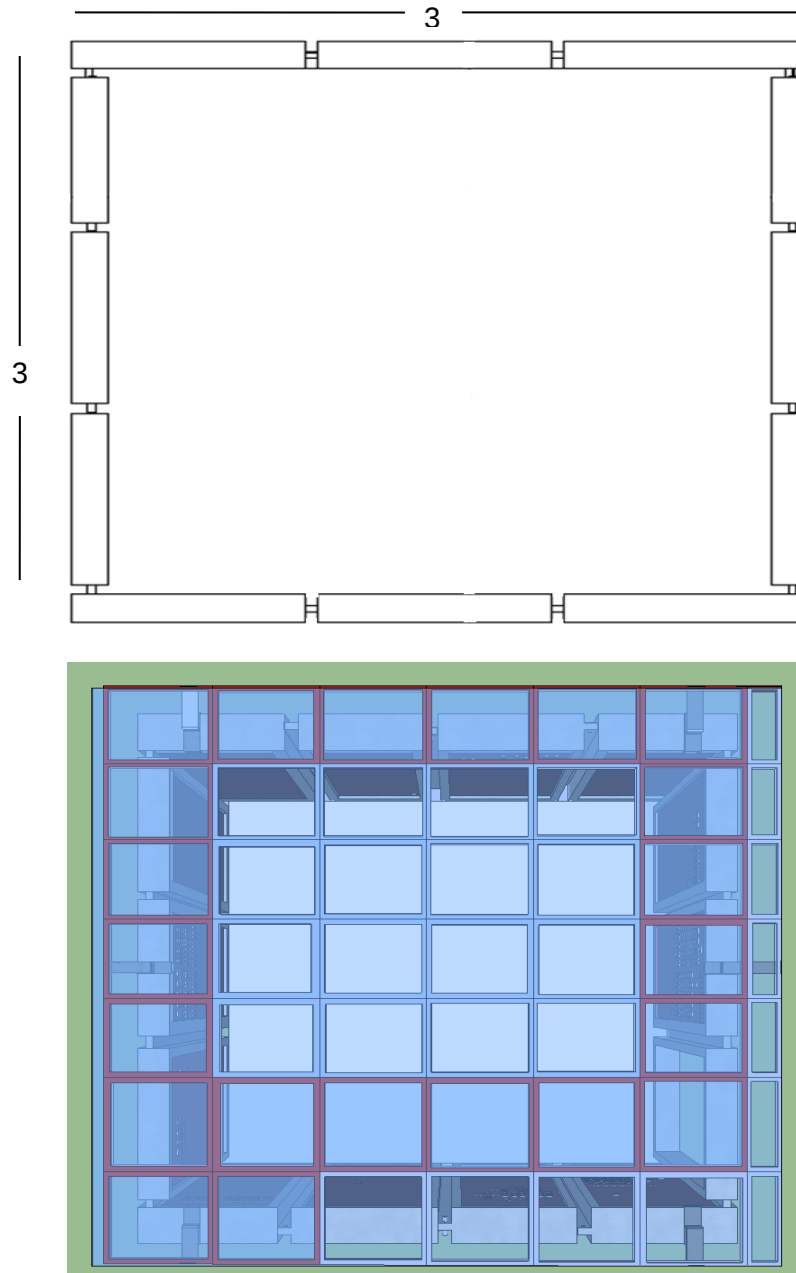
la imagen explica las dimensiones de la planta en cuanto a los módulos y a su vez muestra la parte de la cubierta en planta. Fuente: render realizado en sketchup por camilo Sáenz y Danny Castiblanco
